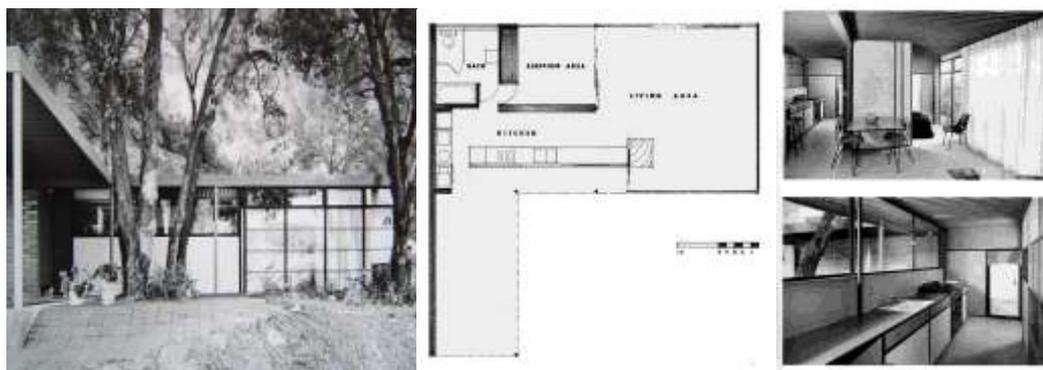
Koenig House: a) Vista da fachada principal; b) Planta; c) Vistas interiores (NEIL, 2007).
